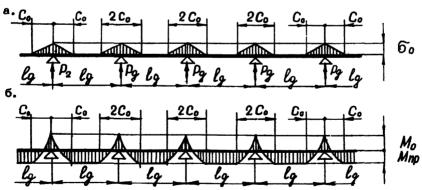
У.3. Расчетные схемы обвязочной балки при поддом-крачивании:
